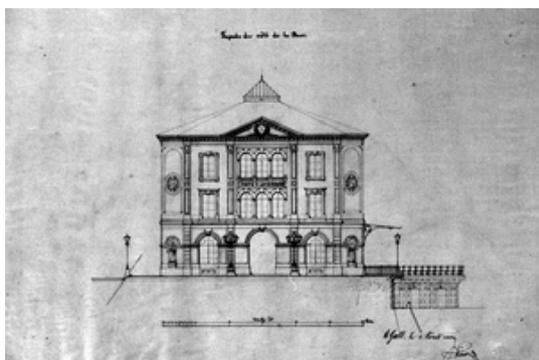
Lausanne, Postgebäude, Plan 7, Fassadenriss «du Côté de la Place», 1863
